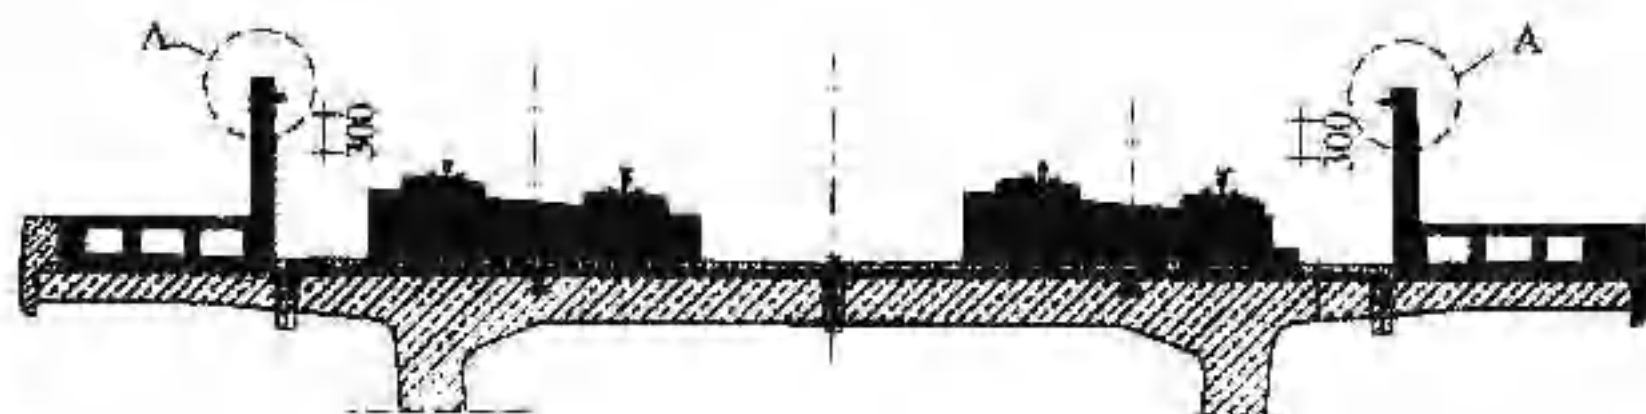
2 桥梁上 CPⅢ埋设示意图 (单位: mm)
